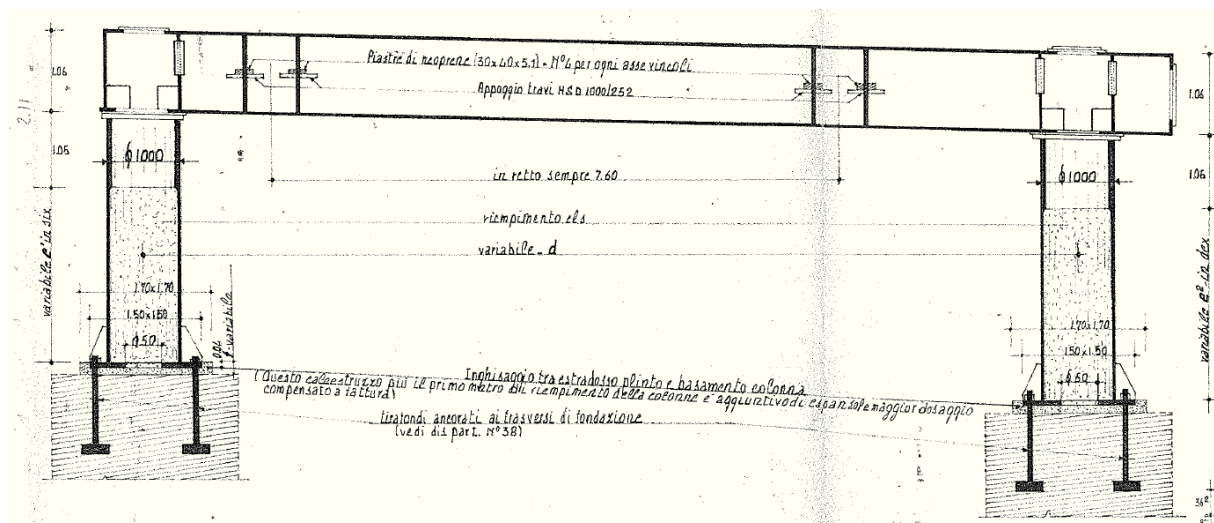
Prospetto sottostruttura (pila) del viadotto esistente
